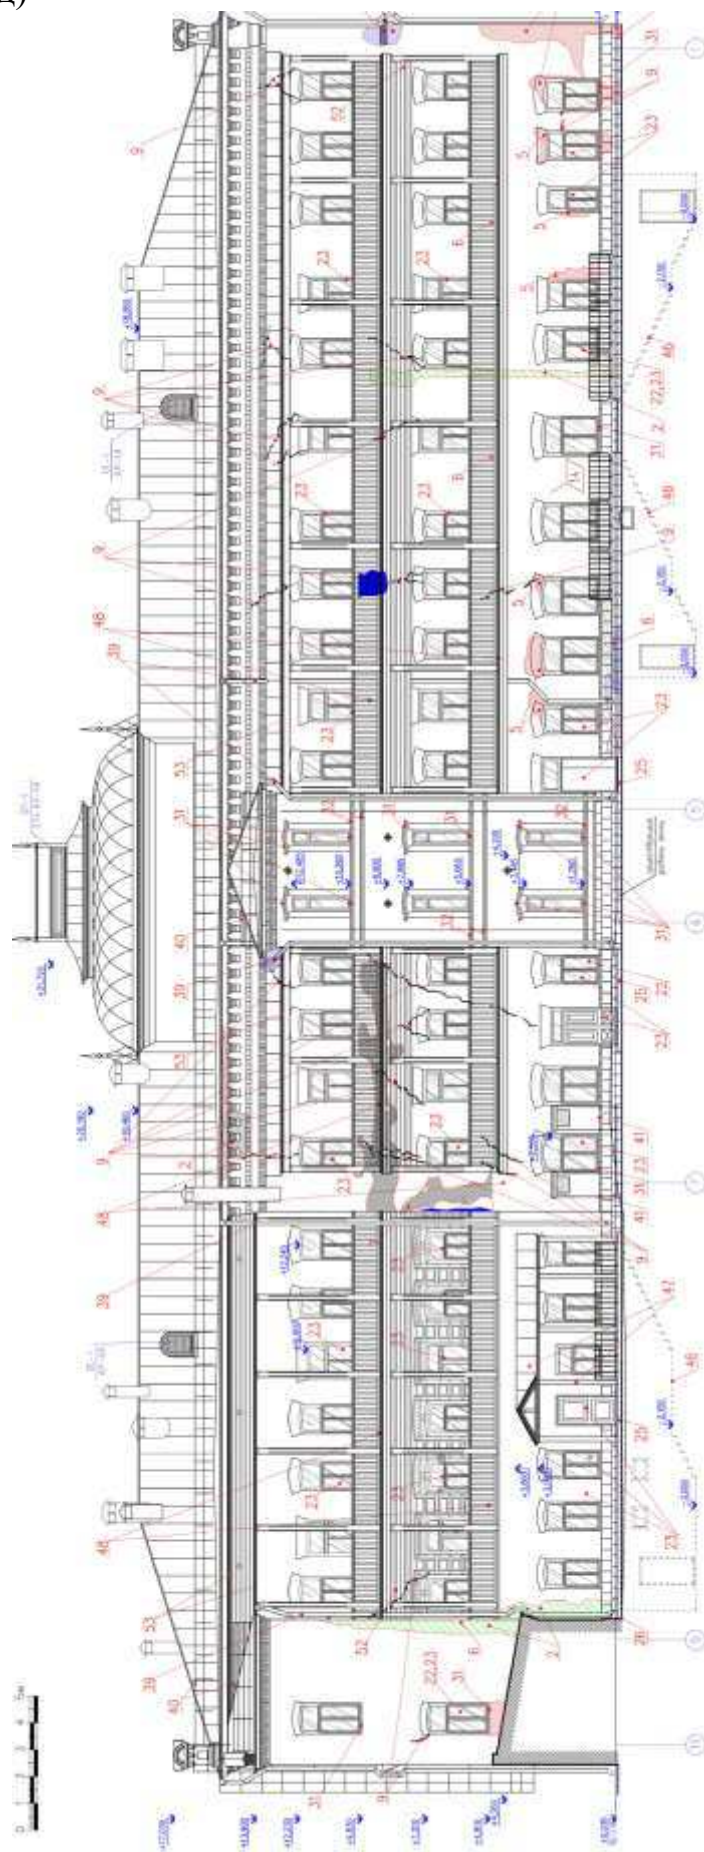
План реконструкции дома Вильнера фасад в осях А-Д
